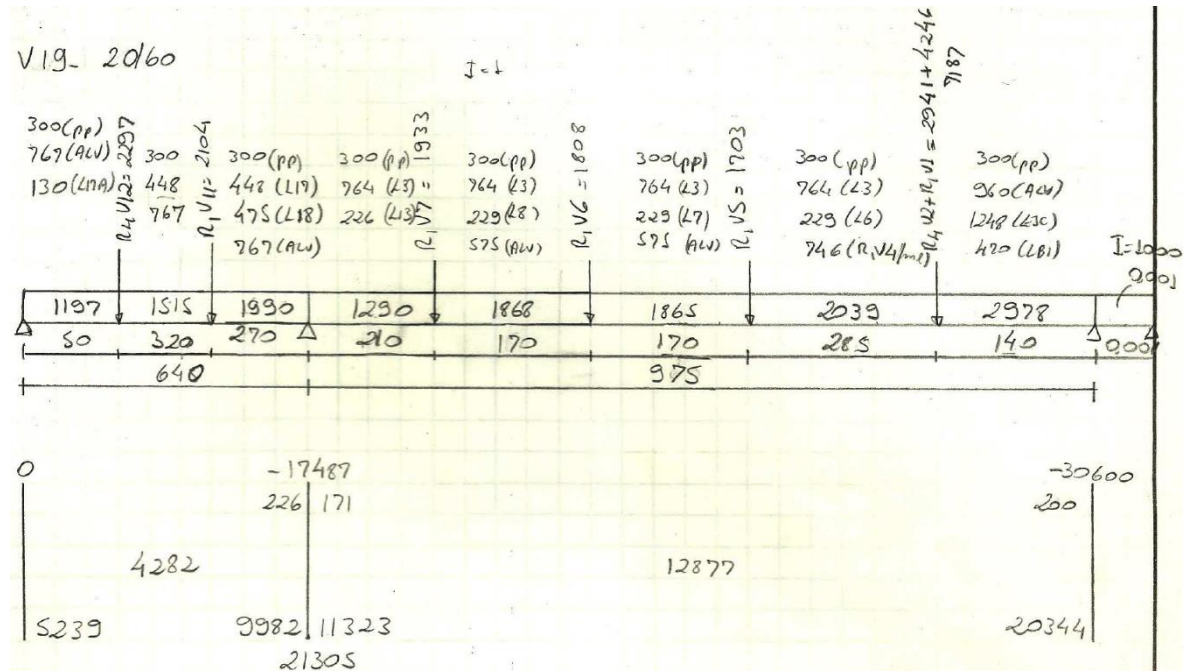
Memória de cálculo, do projeto original, da viga V19 do pavimento tipo, unidades de força em kgf, de comprimento em m.
